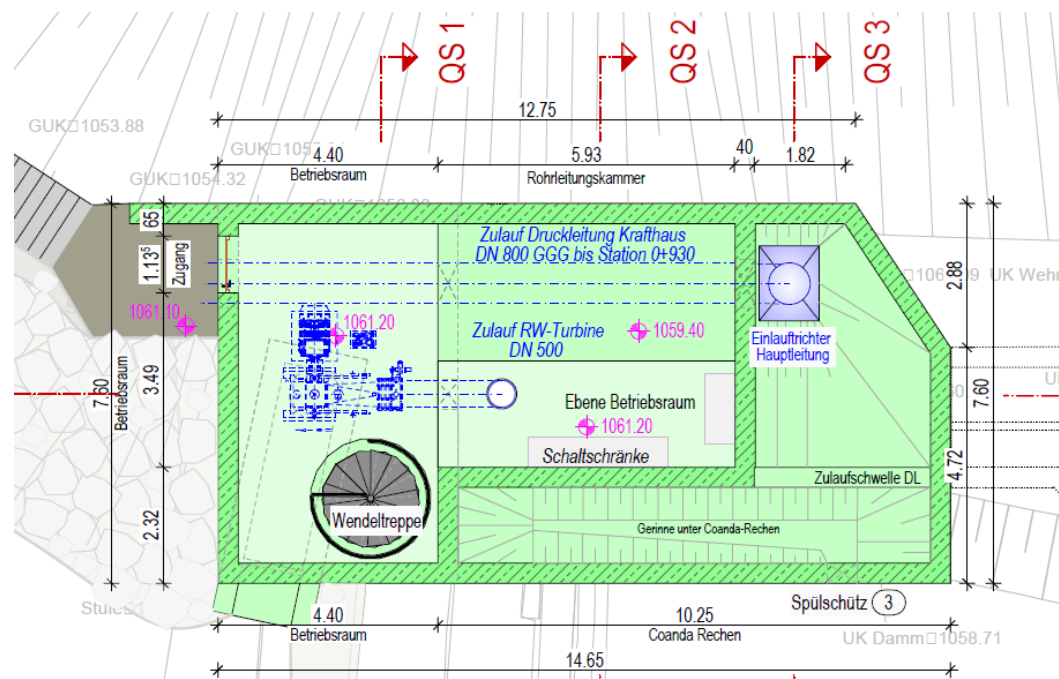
Grundriss geplantes Fassungsbauwerk („Erdgeschoss“)
